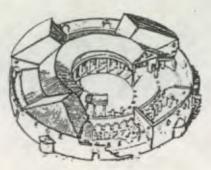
Perspectiva de un proyecto de restauración de San Stefano Rotondo.
